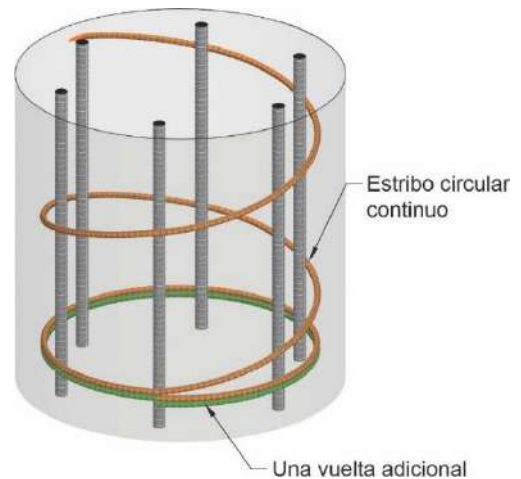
Anclaje de estribo continuo.
